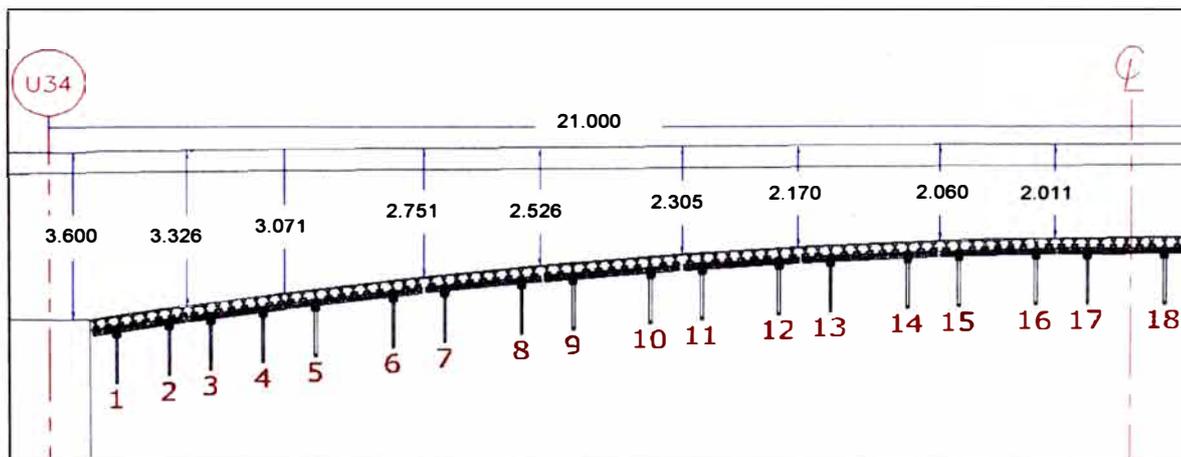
Elevación – Peraltes de la sección de la superestructura (m).
